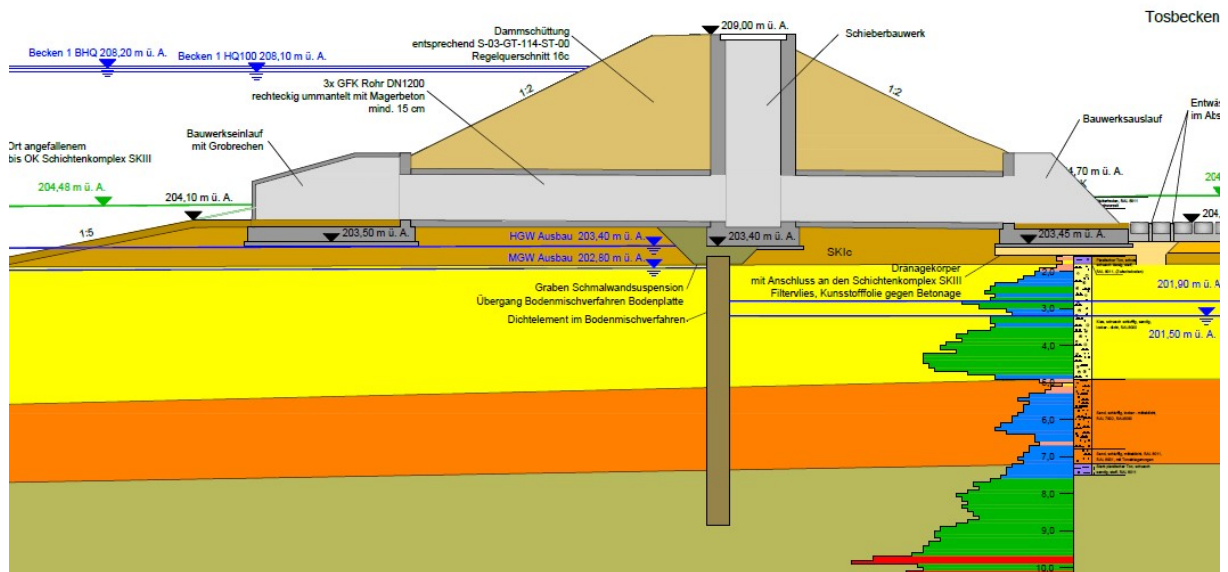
Schnitt durch des Auslaufbauwerk mit Untergrundverhältnissen ([20], Beil. 2)
